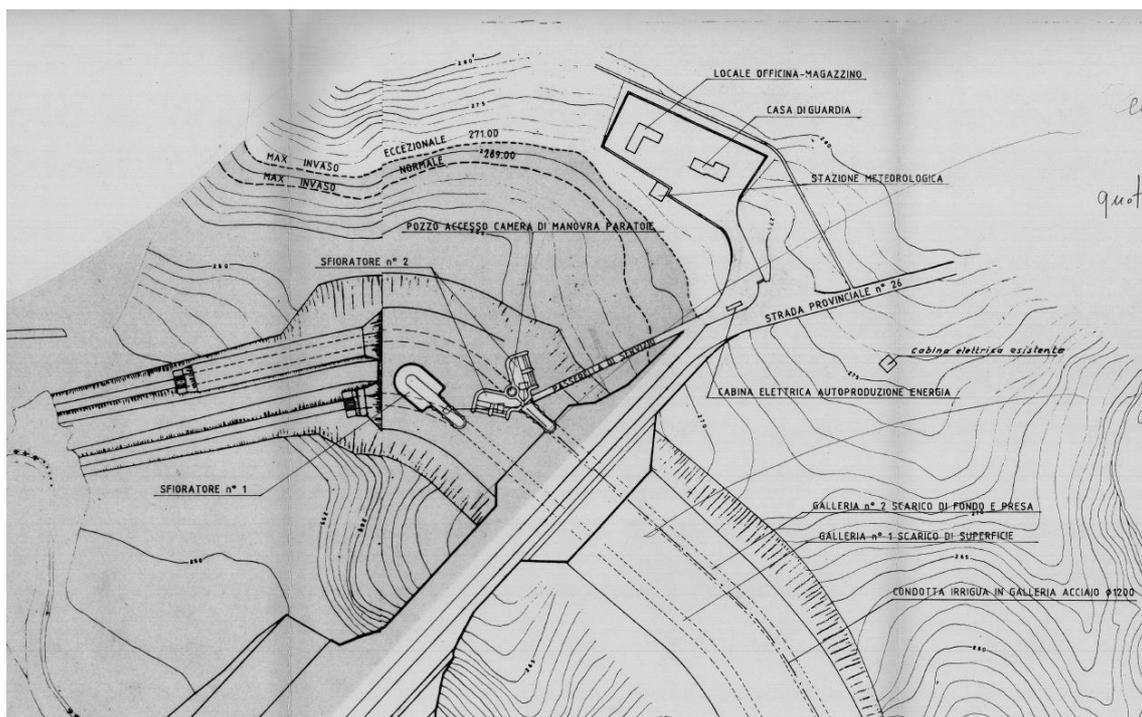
Planimetria degli scarichi di superficie e della casa di guardia (Estratto dell'allegato A.4 – Planimetria generale delle opere esistenti del "Progetto per i lavori di ammodernamento ed adeguamento alle normative vigenti degli impianti elettromeccanici e oleodinamici della diga sul T. Basentello in località "Serra del Corvo" in agro di Gravina in Puglia (BA)", 1994)
